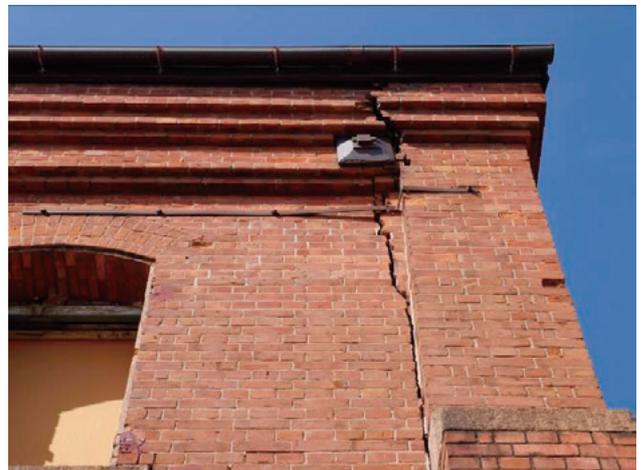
現在の第九庫南西隅の外壁ひび割れ
